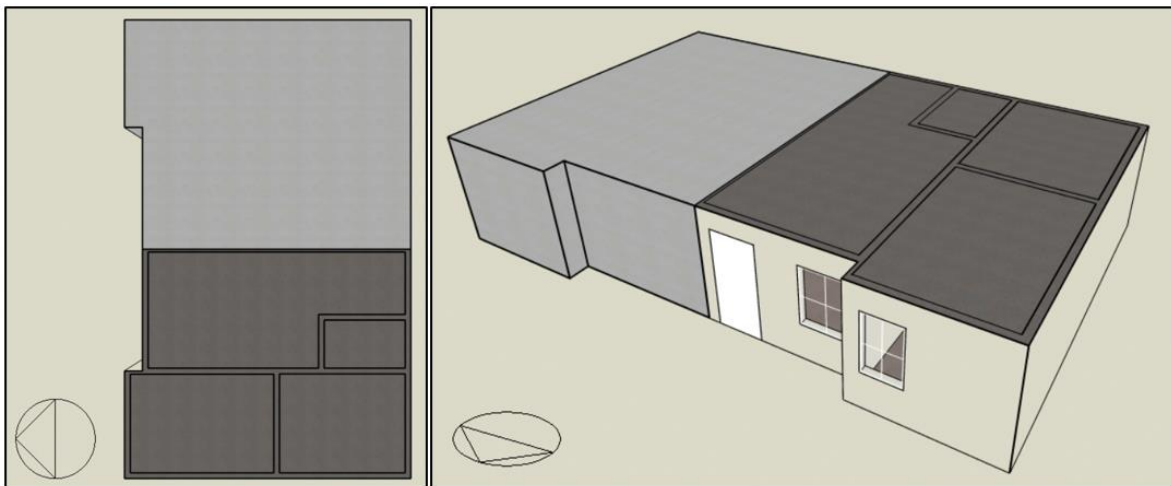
Planta y vista isométrica de la vivienda y la vivienda colindante
